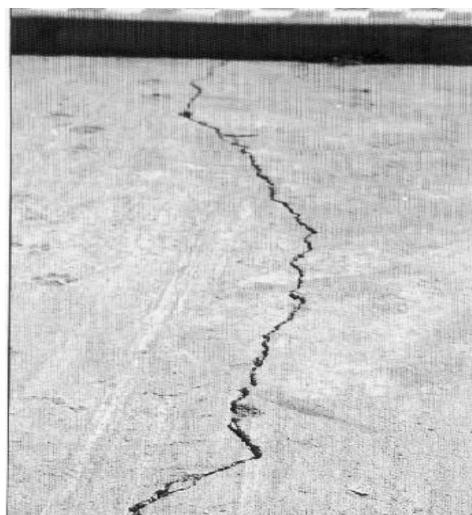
Fisura de retracción en una solera de hormigón sin armadura en su cara superior, consecuencia del fuerte soleamiento durante su fraguado y endurecimiento
